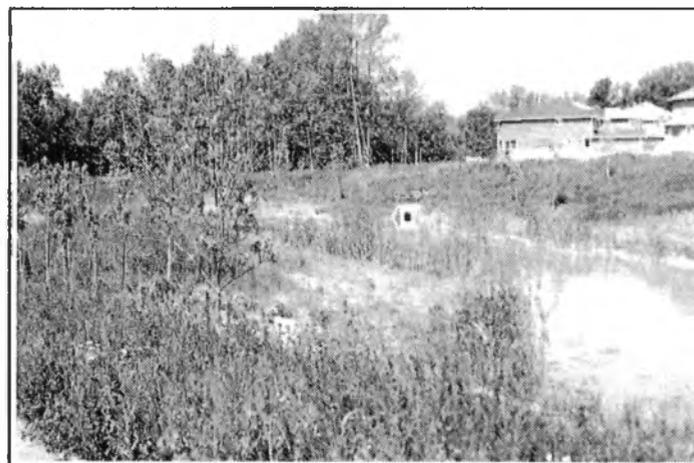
Bassin de retenue d'eaux pluviales à Ajax, en Ontario. Photo prise après la construction.
